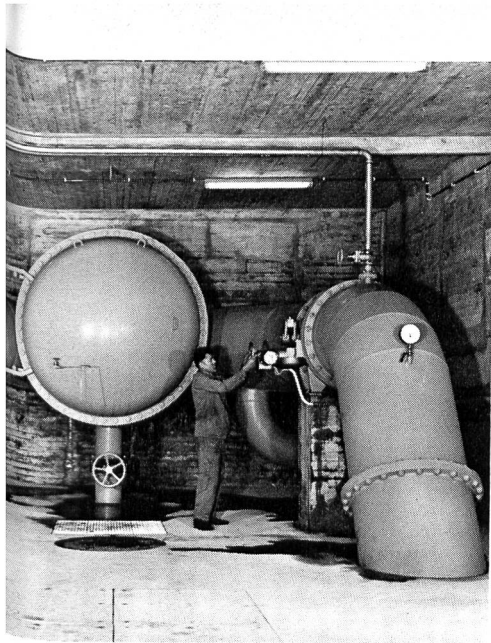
Stolleneingang Strickhof, Stahlleitung Ø 2,00 m mit Abgangsleitungen
